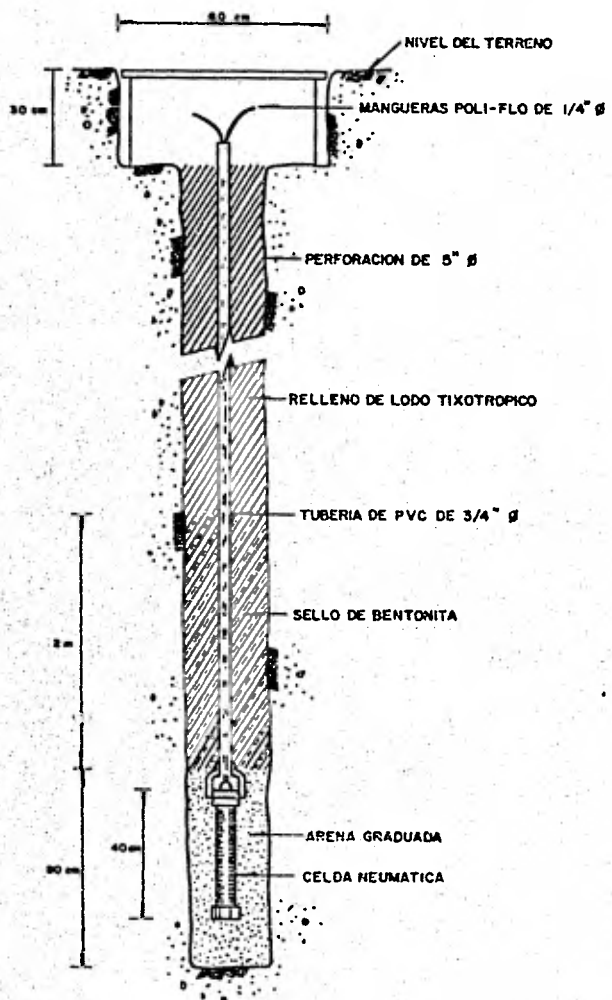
Detalle de la instalación de piezómetros neumáticos
